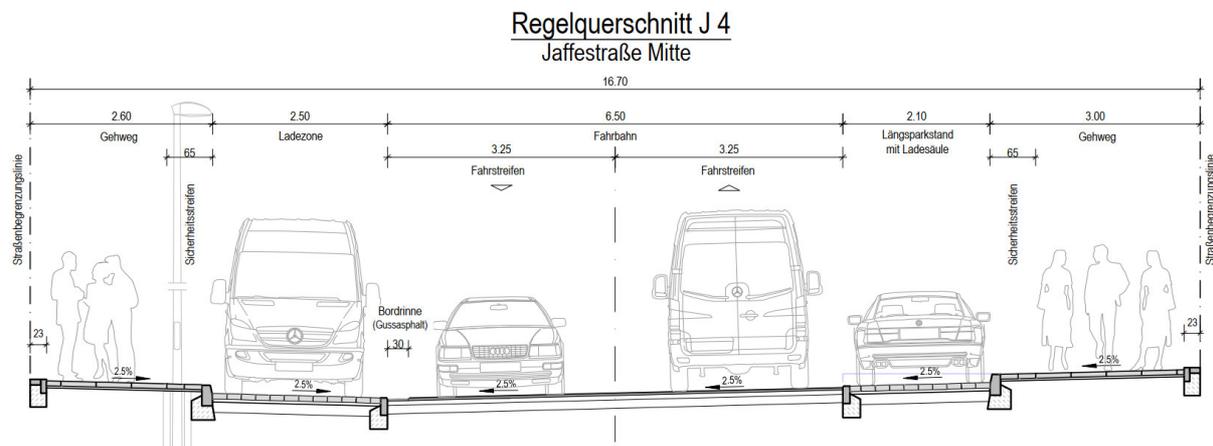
Querschnitt Jaffestraße zwischen Rotenhäuser Wettern und Einmündung Planstraße A
